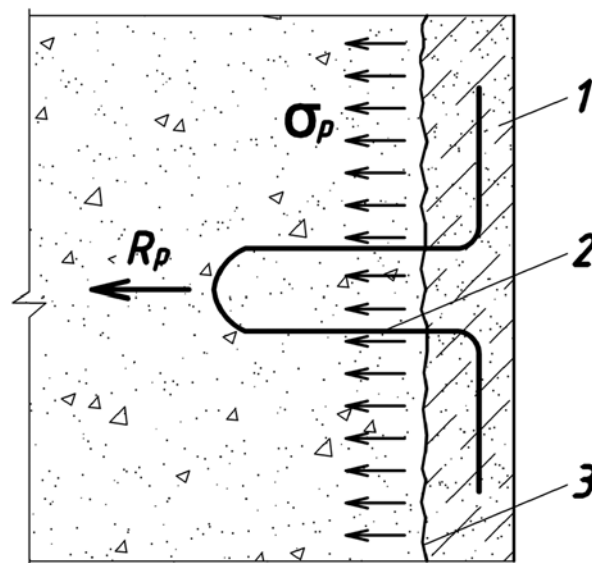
Расчетная схема для определения числа анкерных петель: 1 – опалубочный фибробетонный элемент несъемной опалубки; 2 – анкер несъемной опалубки; 3 – активная поверхность элемента несъемной опалубки
